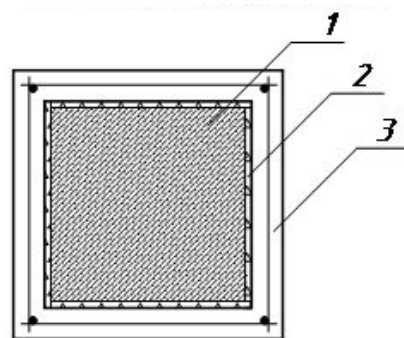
Наружная усиливающая конструкция колонн: 1 – железобетонная колонна, 2 – обмазка из жидкого стекла с добавлением цемента, 3 – железобетонная обойма
